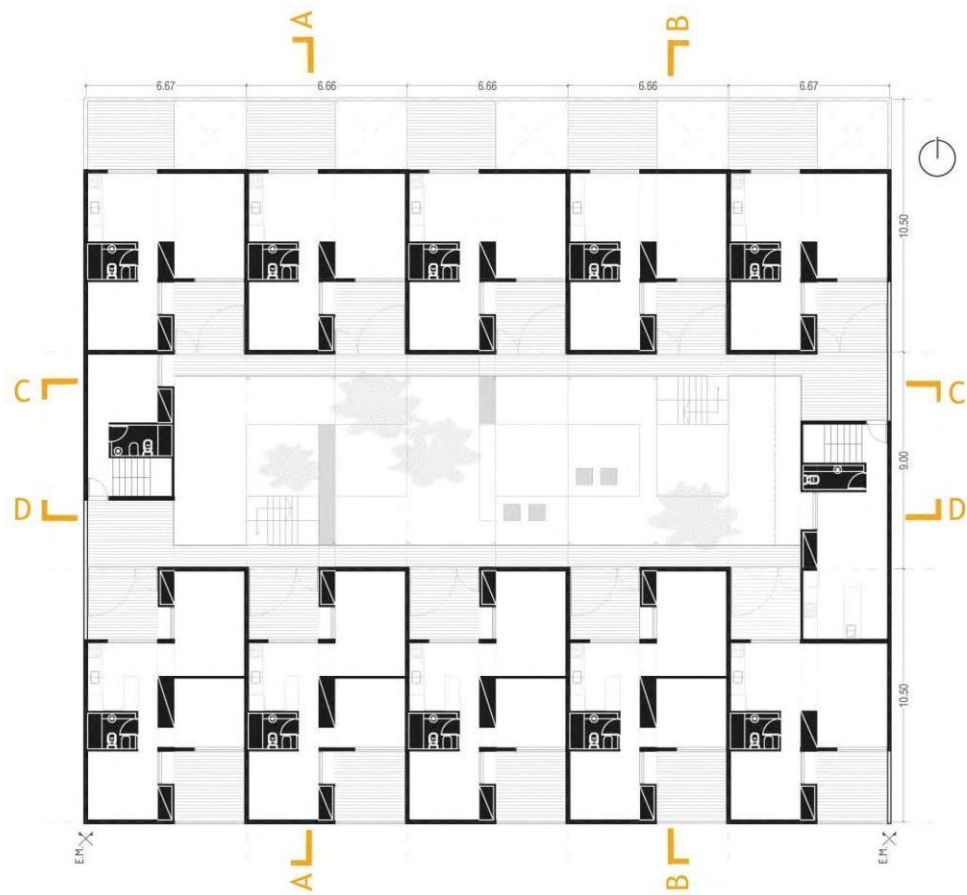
A: Planta nivel II. Tomada de: Arch Daily
